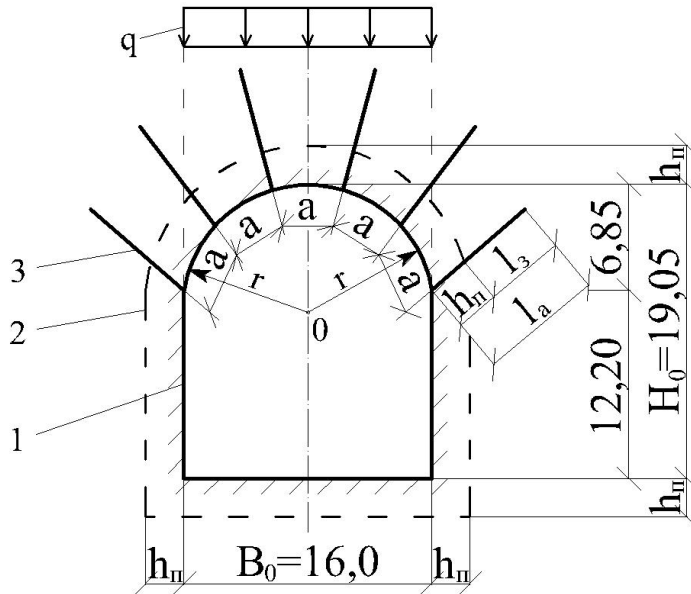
Схема для розрахунків анкерного кріплення склепіння тунелів без обробки: 1 – поверхня виробки, 2 – границя порушеної зони, 3 – залізобетонні анкери
